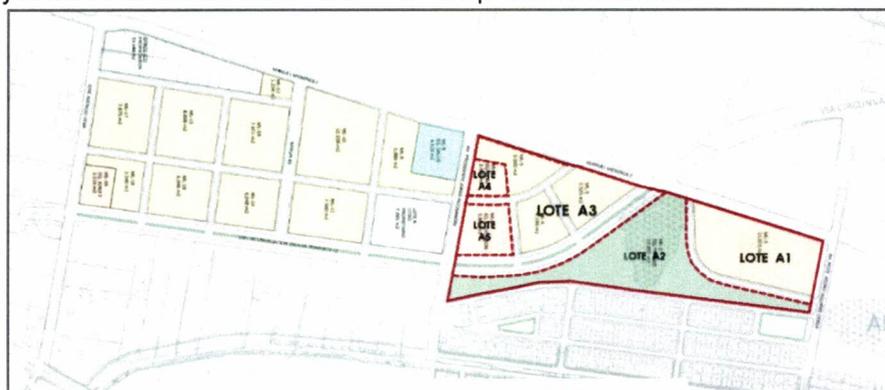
PLAN MAESTRO PUH PUNTA ARENAS_ ETAPA 1
